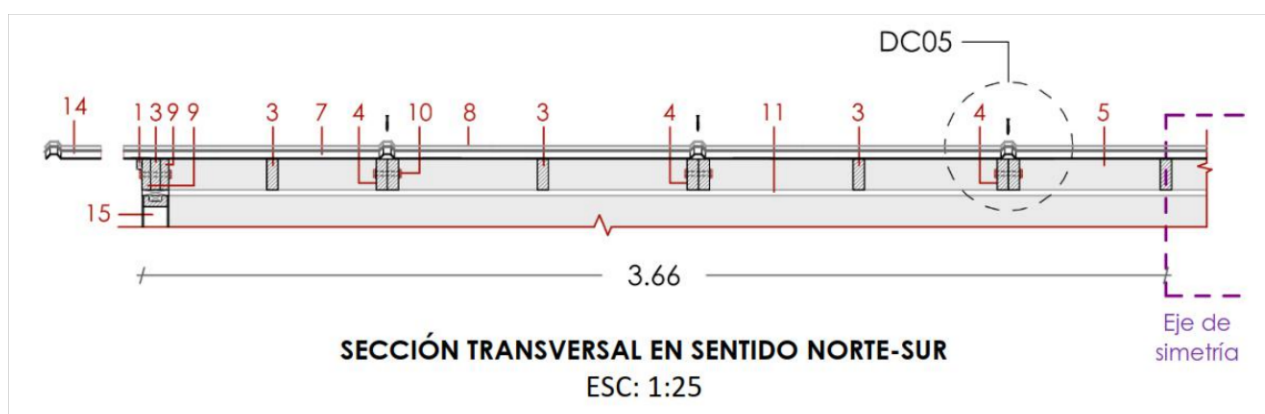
Media sección transversal de la cubierta en sentido norte-sur para la propuesta de estudio.
